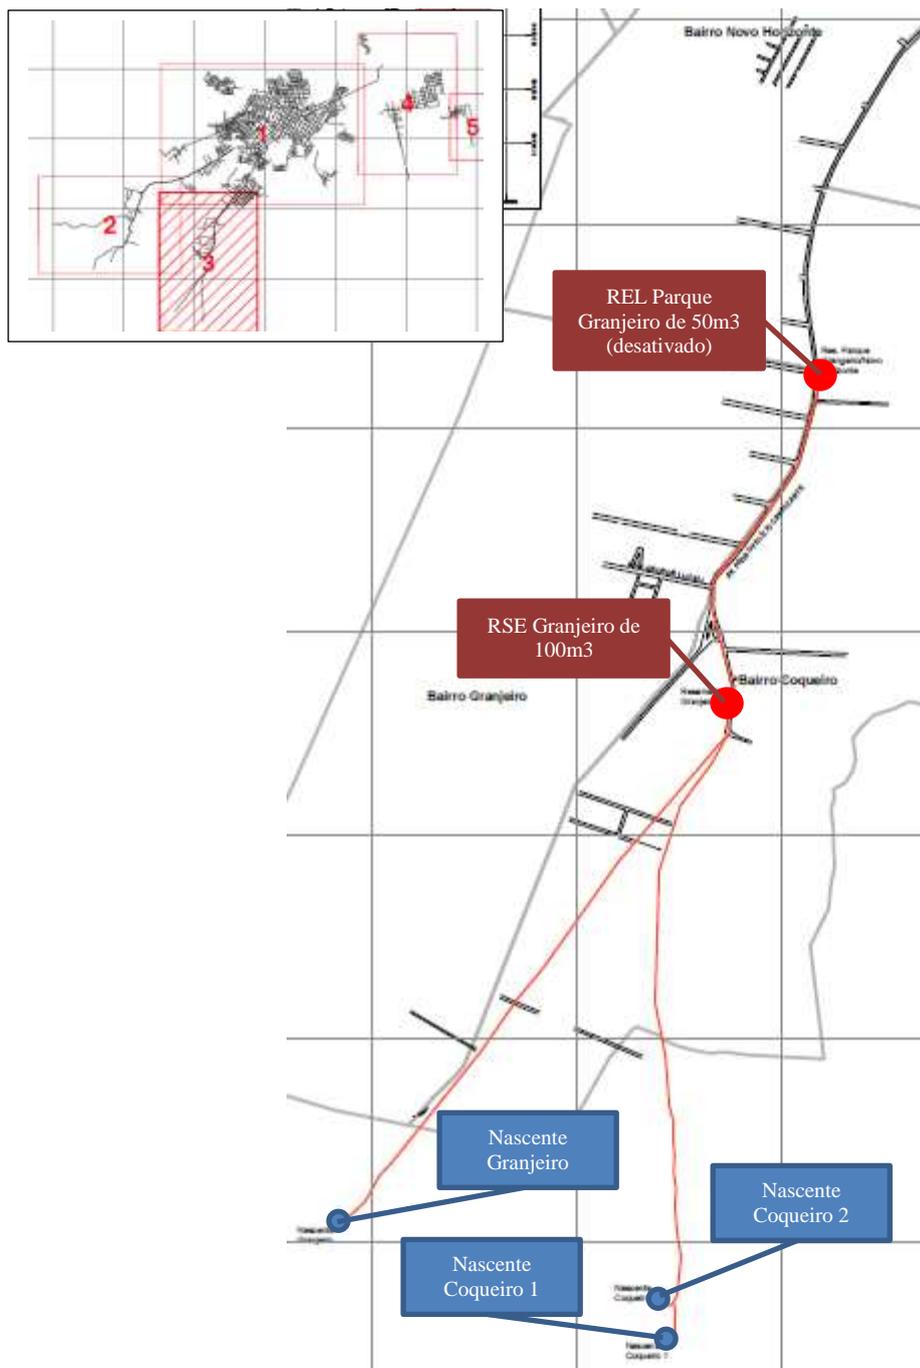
Croqui do sistema de abastecimento de água da sede do Crato.
